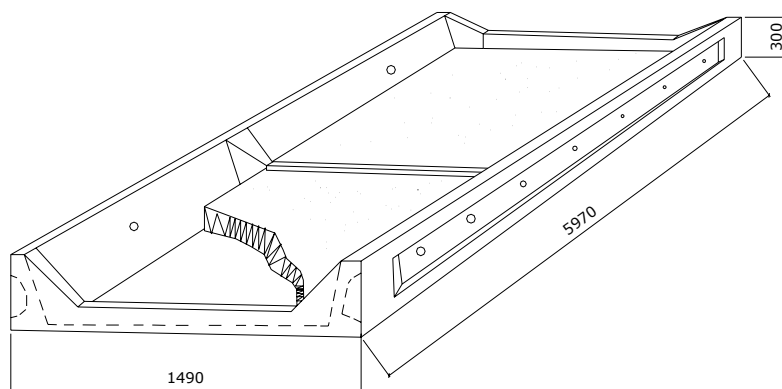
Комплексна керамзитобетонна попередньо напружена плита з ребрами догори
